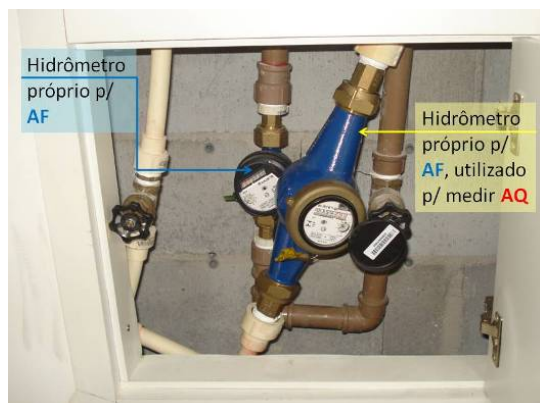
Hidrômetros individuais instalados em cada pavimento tipo, antes da intervenção.
